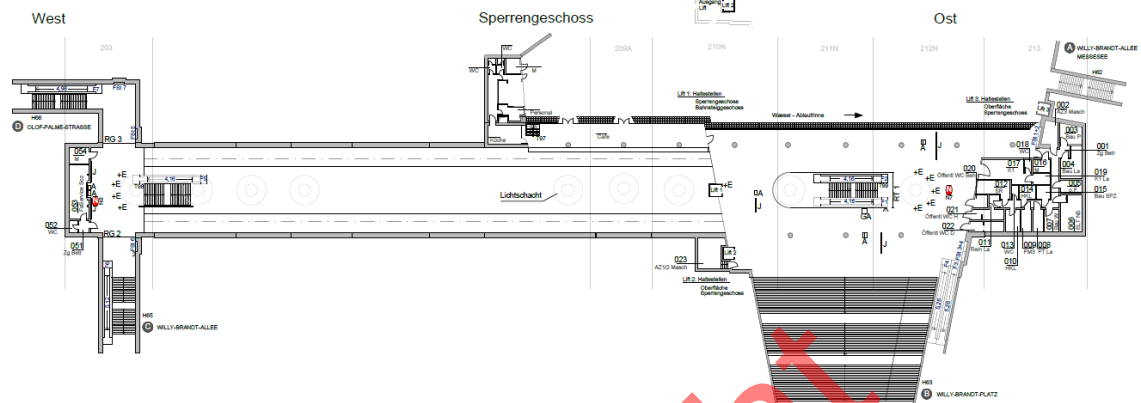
Grundriss Sperrengeschoss ME
